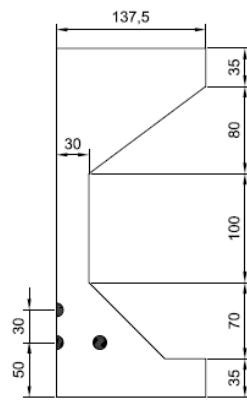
Element met voorspanstrengen in bovenste en onderste zone [16, p. 127]
